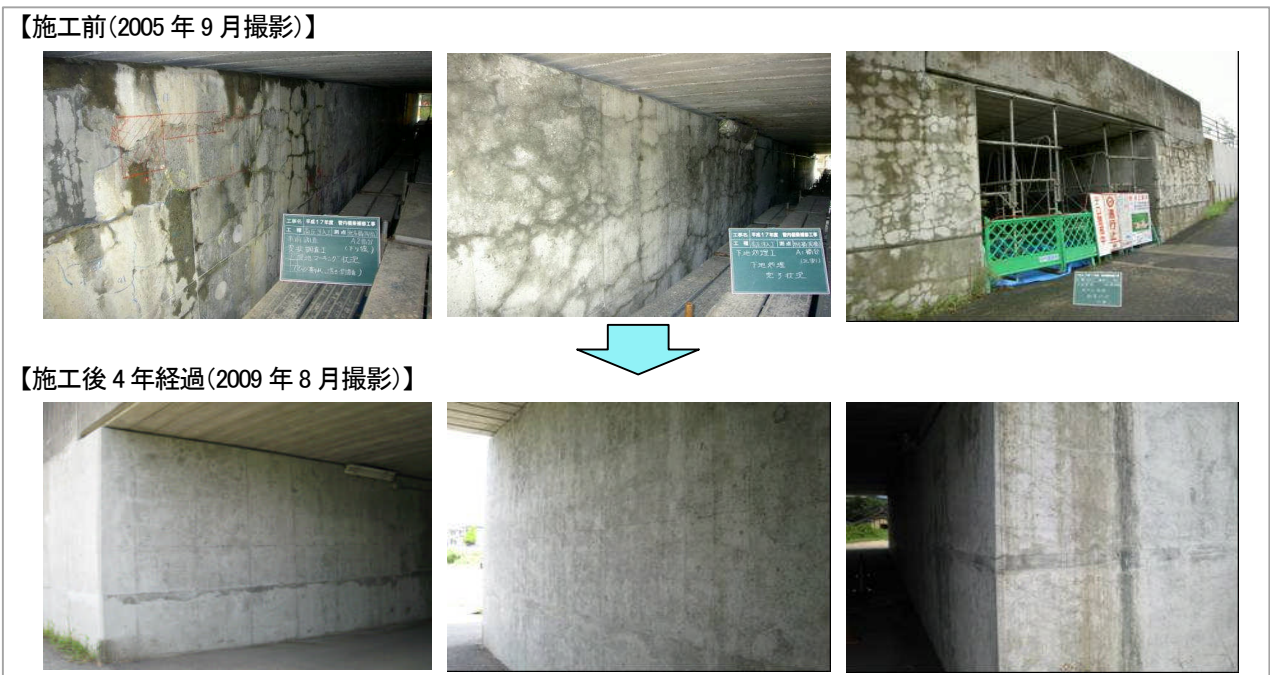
陶橋橋台 施工前状況と施工後4年経過時の状況
